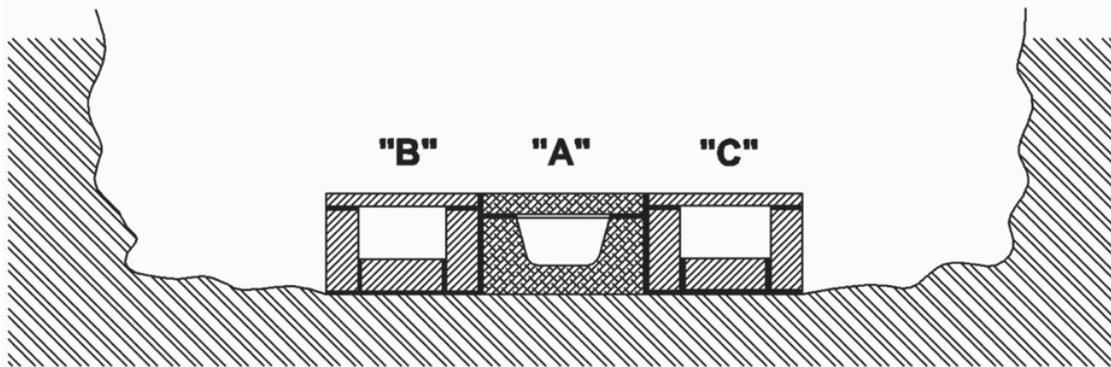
"Pavimento attrezzato". Al centro la canaletta realizzata con "docce", elementi componibili in arenaria - Punto n. 13 nella planimetria generale.
